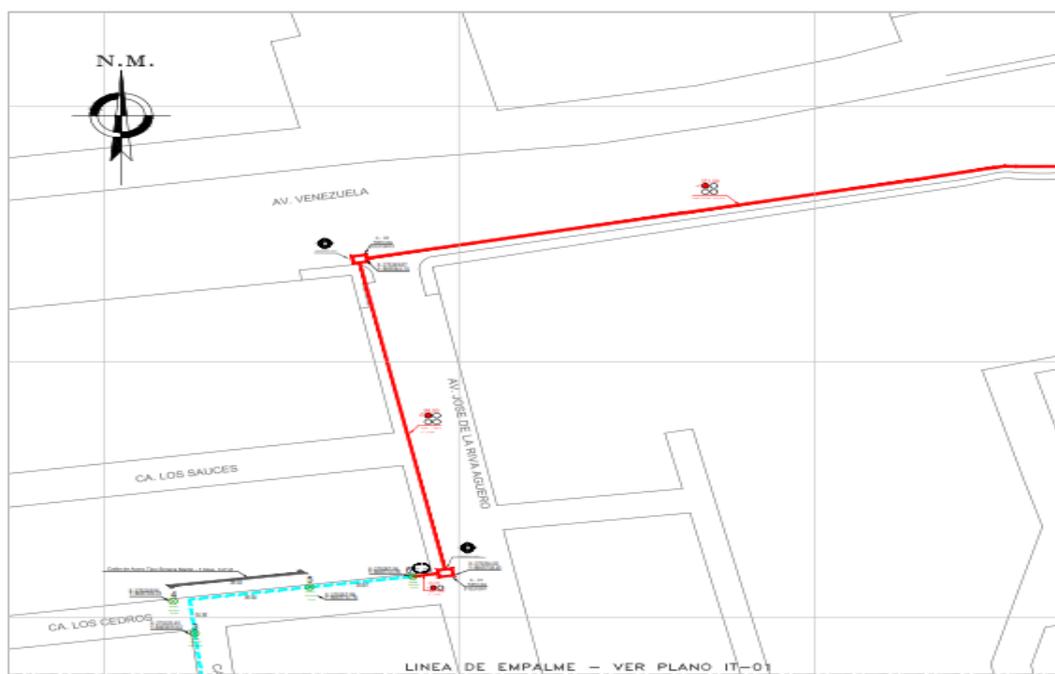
Plano de instalación de F.O. - tendido aéreo y canalizado
